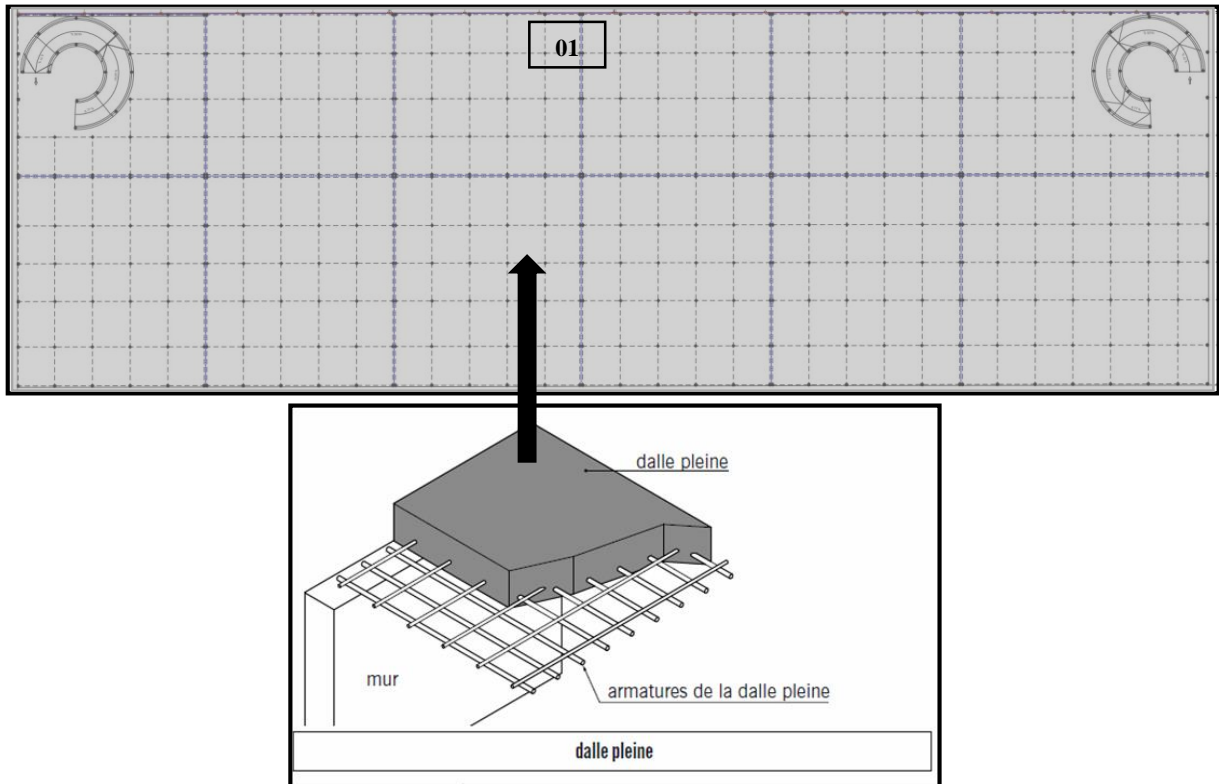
Plancher dalle pleine en béton armé / source : par l'auteur
